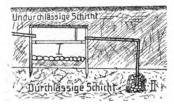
Ausmündung einer Brunnenftube, Draufficht.
